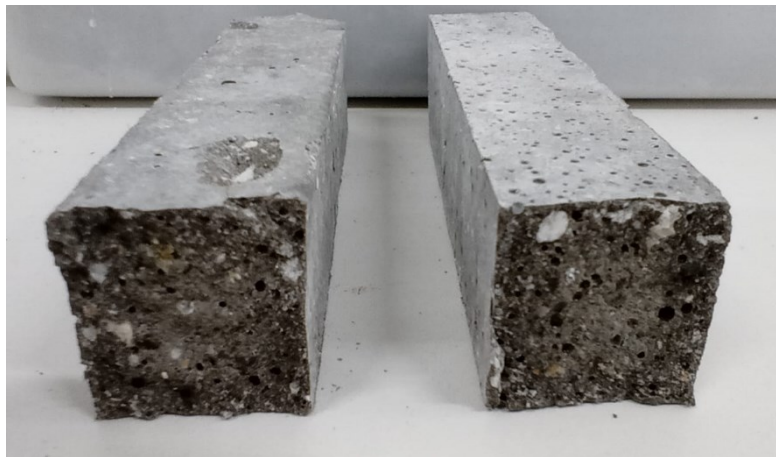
Seções de barra de argamassa traço 10 RVM após ensaio de expansão
